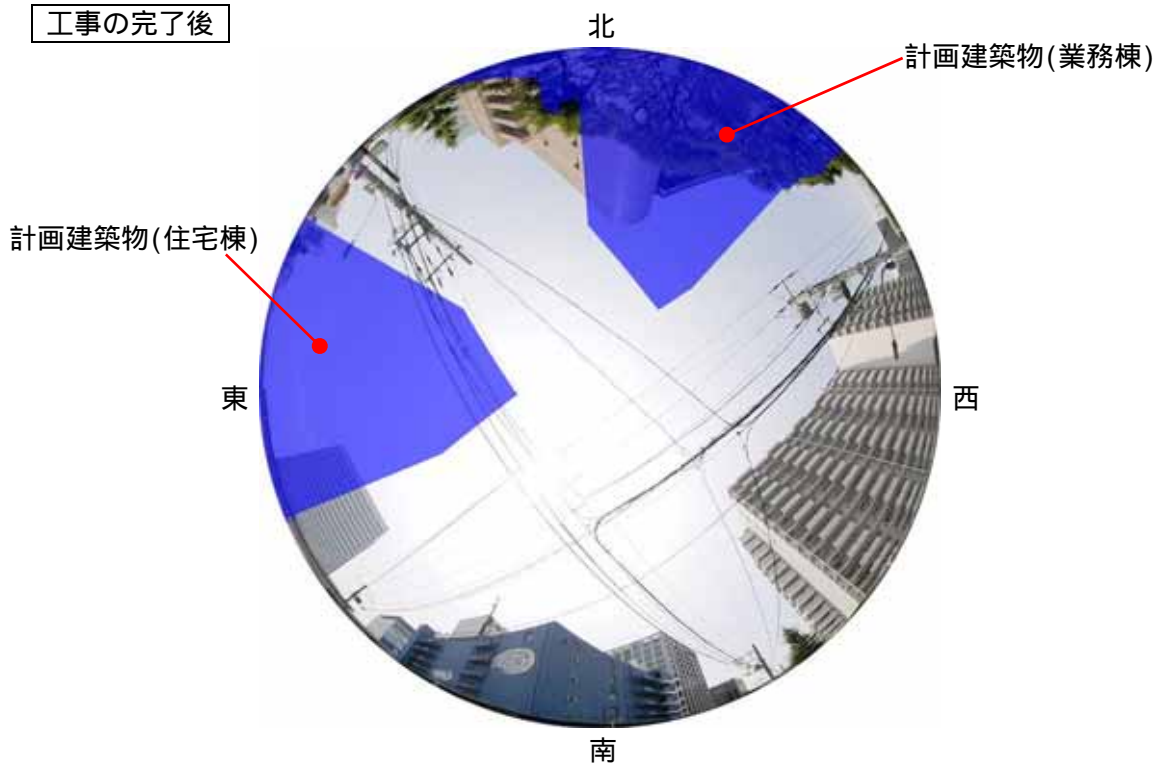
(1) 天空写真(No.3 地点：業務棟南東側角)【変更後】
